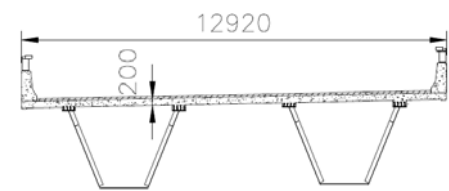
Coupe du pont sud sur les poutres-caissons en acier
